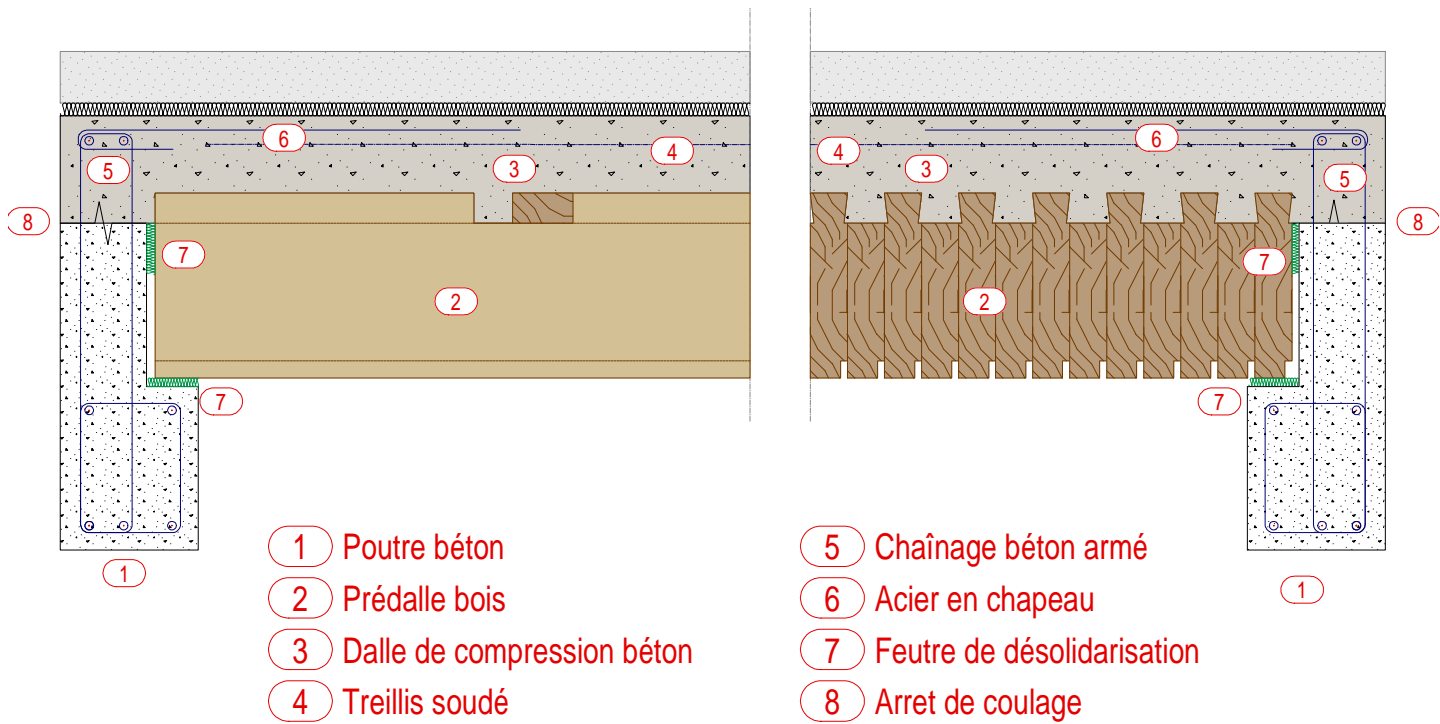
Chaînage du plancher LIGNADAL sur ossature béton en zone sismique
